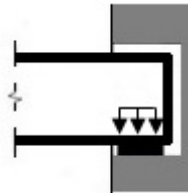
Tensiones de compresión en el apoyo de una viga.
